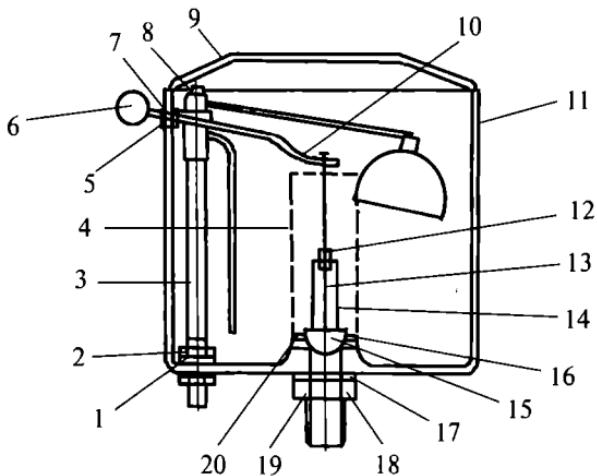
Смывной бачок с нижней подводкой воды: 1 — резиновая прокладка и металлическая шайба; 2, 5, 21 — контргайки; 3 — стойка; 4 — перелив; 6 — ручка; 7 — втулка механизма спуска; 8 — вертикальный поплавковый клапан; 9 — крышка бачка; 10 — рычаг; 11 — корпус бачка; 12 — втулка; 13 — тяга; 14 — дуга; 15 — груша; 16 — резиновая прокладка седла; 17 — резиновая прокладка; 18 — металлическая шайба; 19 — гайка седла; 20 — седло
